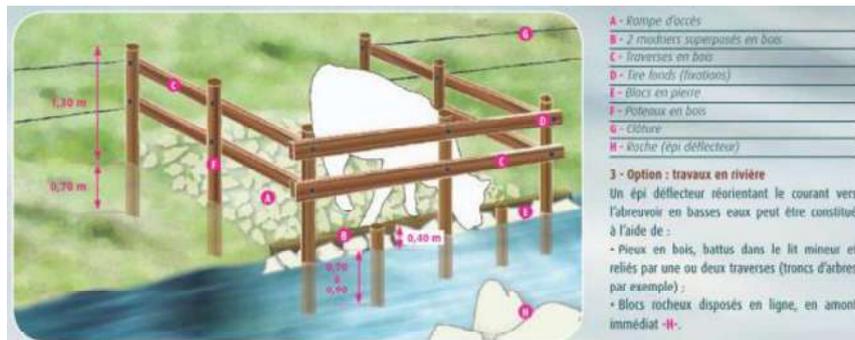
Principe de construction d'une rampe empierrée pour l'abreuvement au fil de l'eau (Guide technique du PNR du Morvan, 2011)
